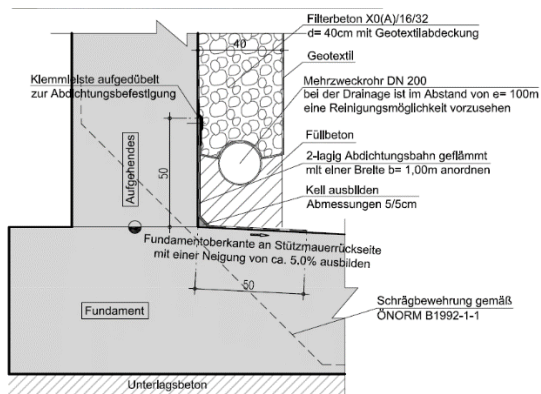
Detail Fußpunkt Stützmauer mit erdseitiger Abdichtung
